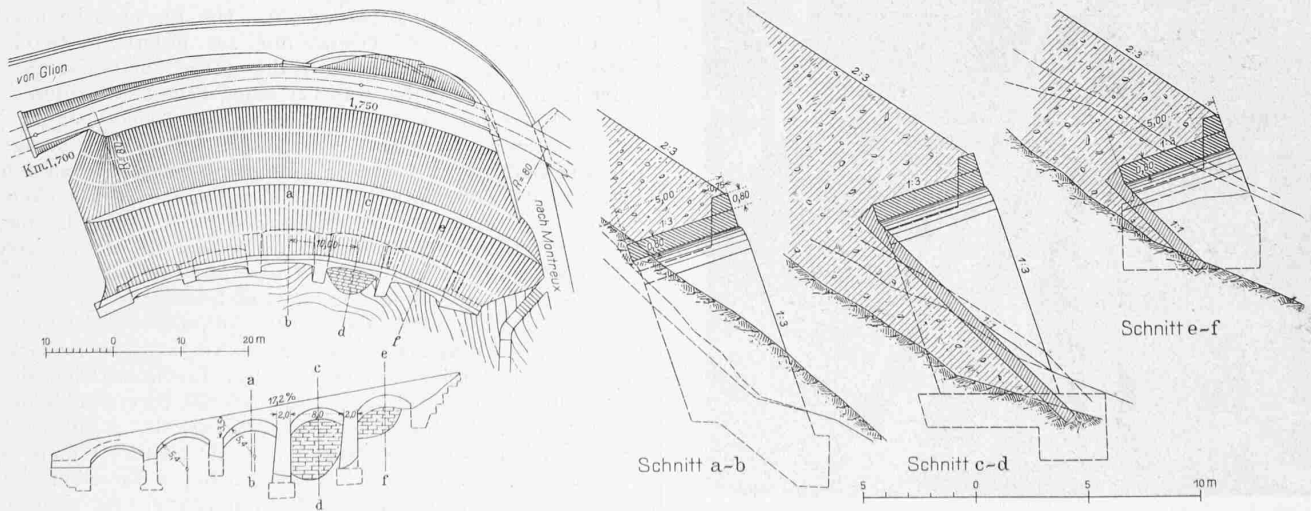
und 21. Lageplan und Ansicht (1:1000) und Schnitte (1:300) der Lehengalerie in Abb. 22 für die Tunneldeponie.
